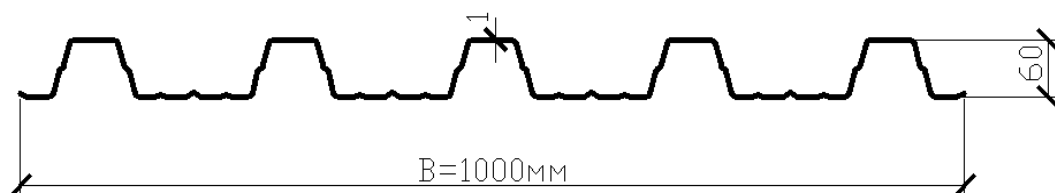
Сечение стальной арочной заготовки А-Н60-845-1,0
